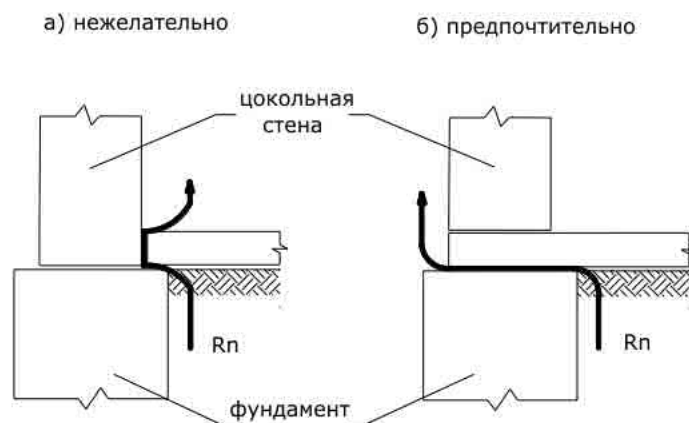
Нереконструируемое и рекомендуемое решения узла сопряжения плиты пола с фундаментом
